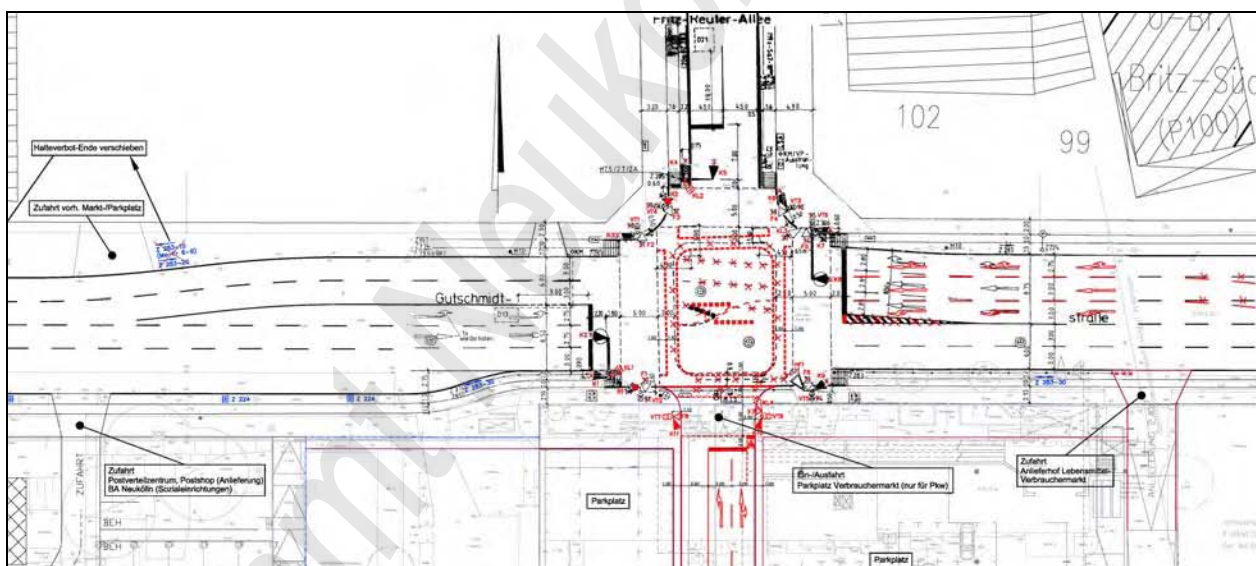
Lageplan Verkehrserschließung (GRI, August 2006)
